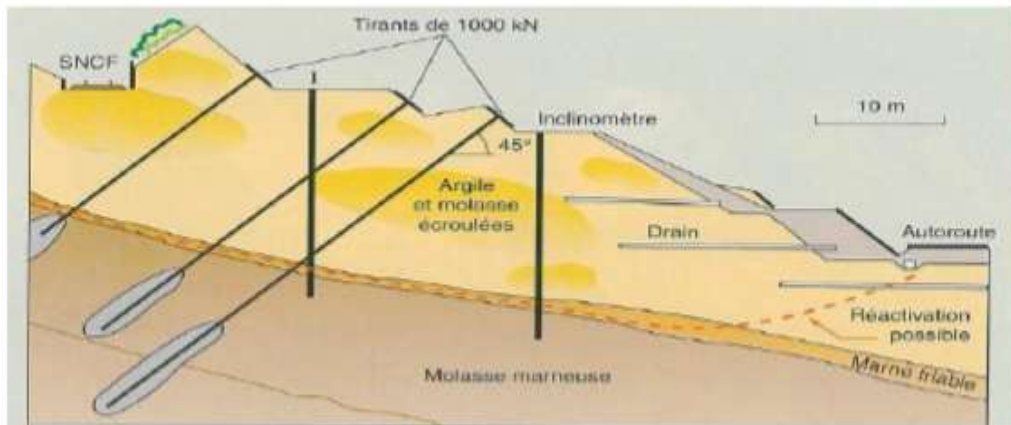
Renforcement par tirant sur l'autoroute A 41, (Haute-Savoie).
